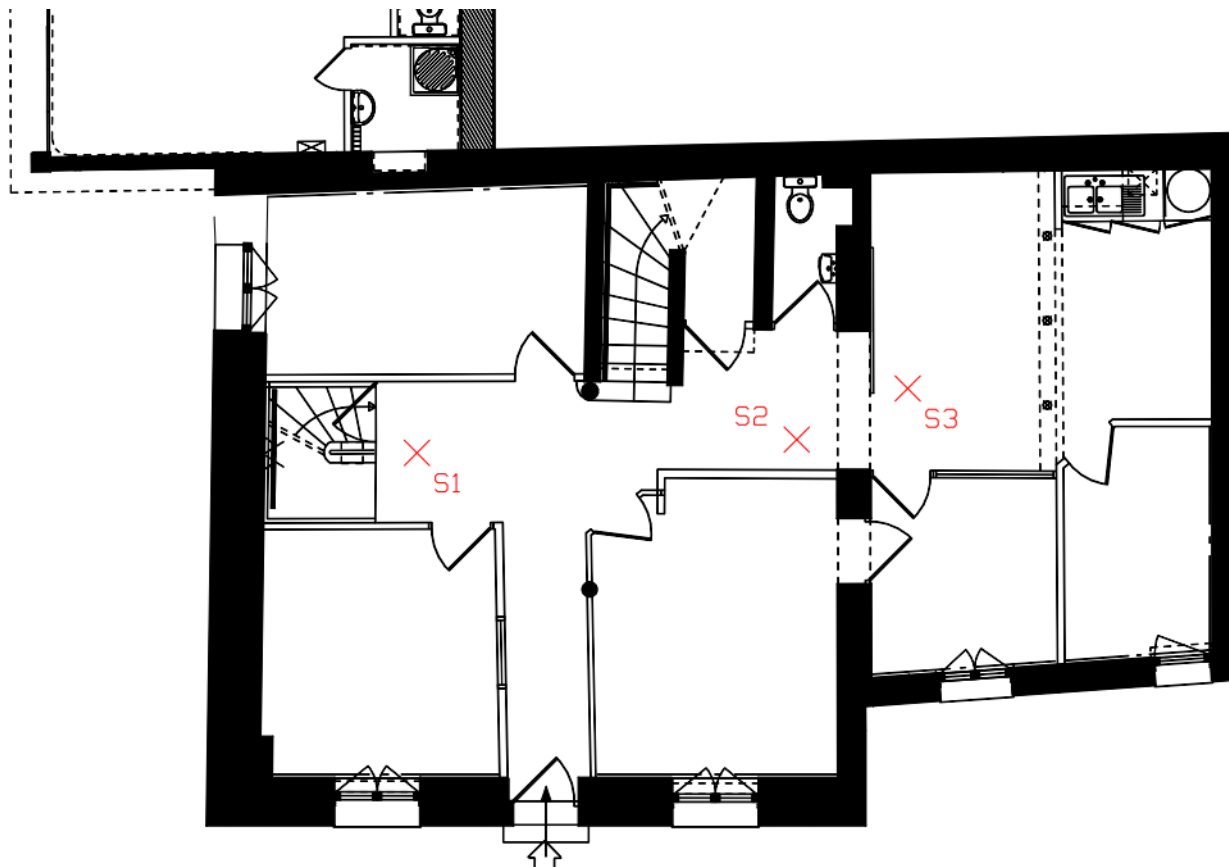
Implantation et repérage des sondages de planchers du bâtiment RH
